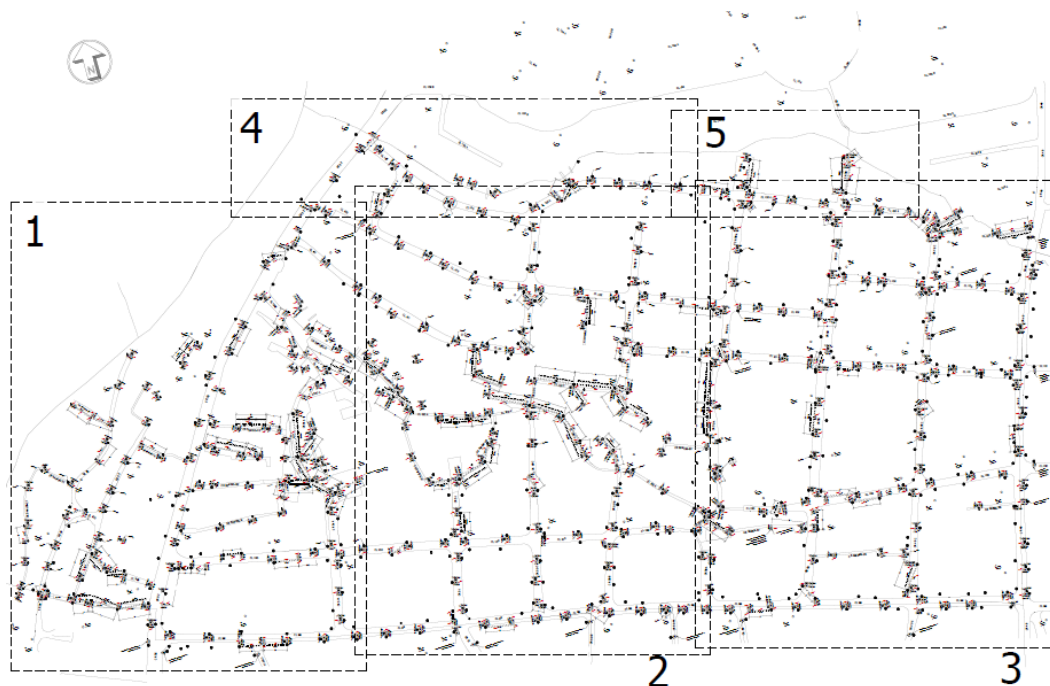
Plano del proyecto SS 172392 BARRIO SANTA CRUZ
